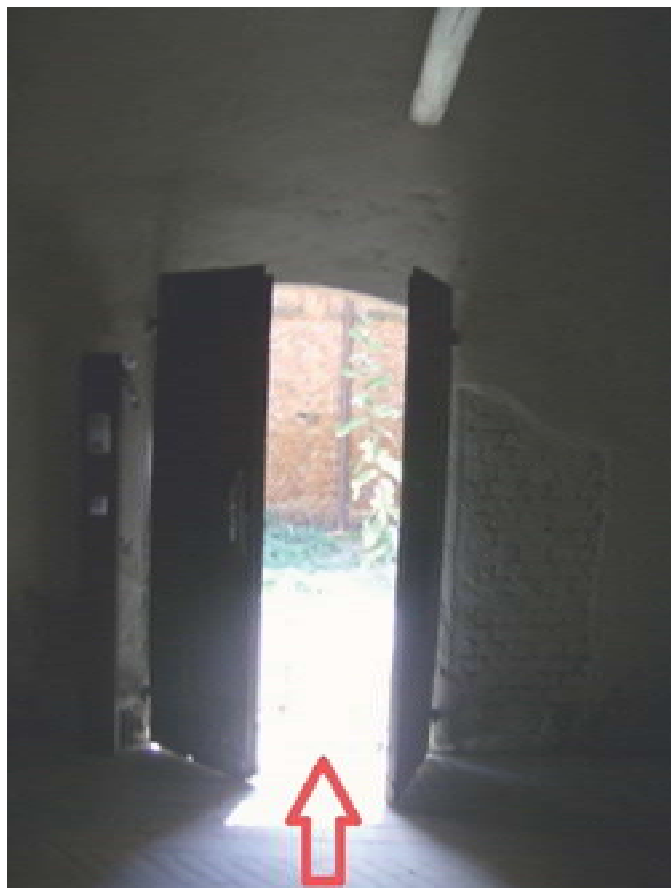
porta di accesso all'u.i. Sub.10 -*lotto n.3* -
